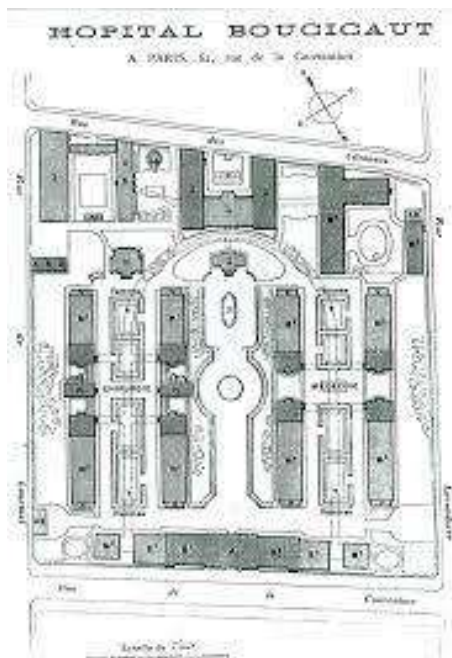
L'Hôpital Boucicaud ; plan du rez-de-chaussée.
